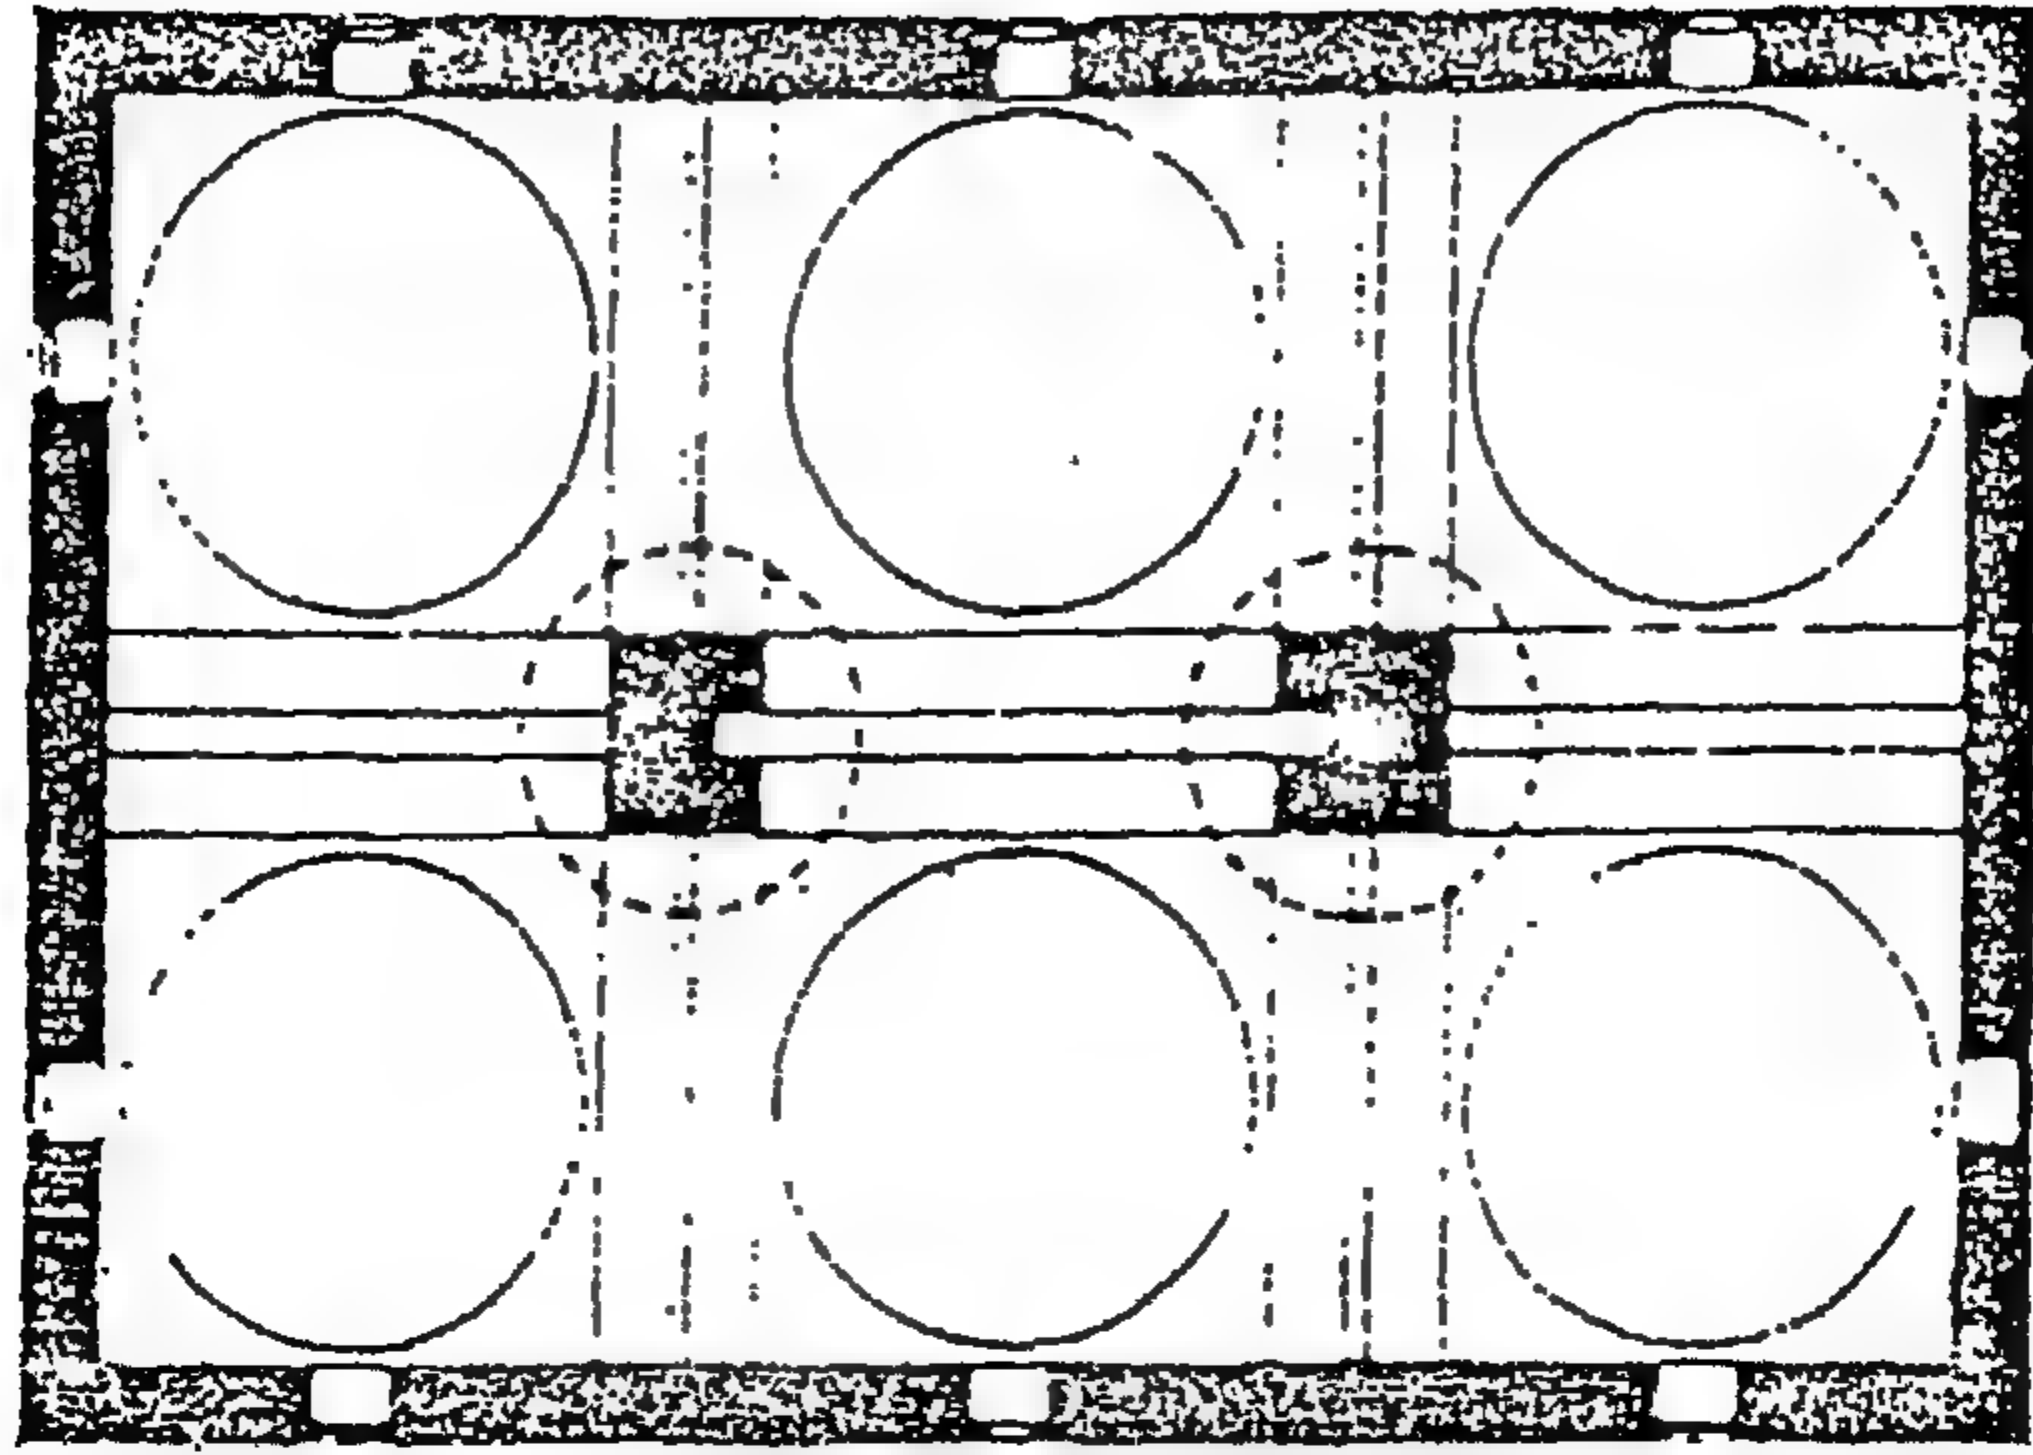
مسقط أفقى لوالده خان فى استانبول (عن : جودوين) .
